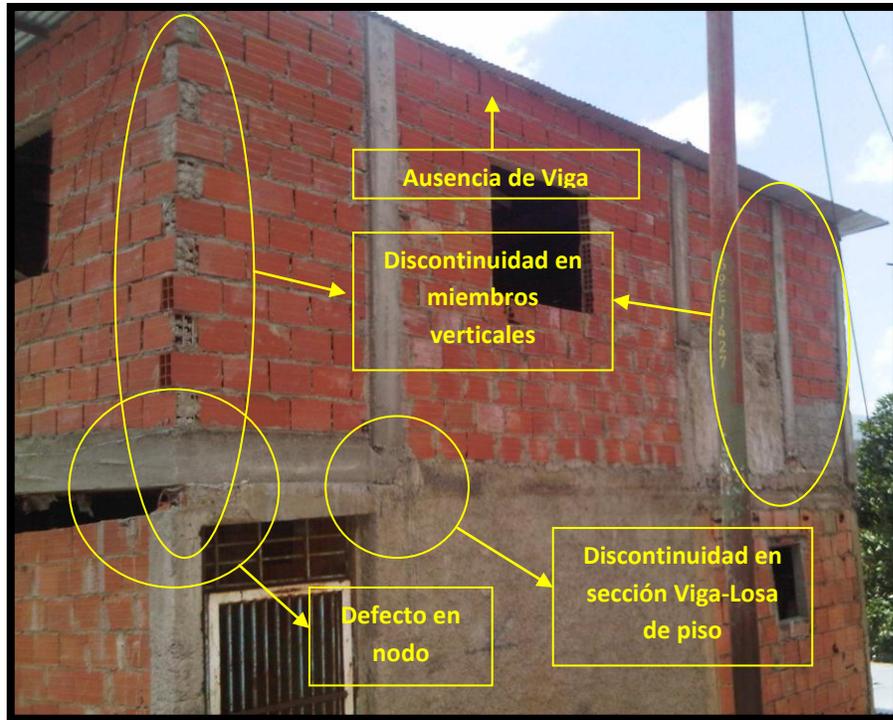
Serie de irregularidades en elevación. Sector El Refugio.
